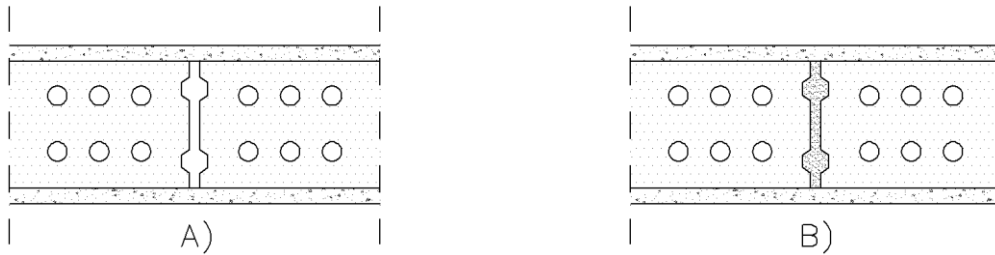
A) Giunto verticale errato – B) Giunto verticale corretto
